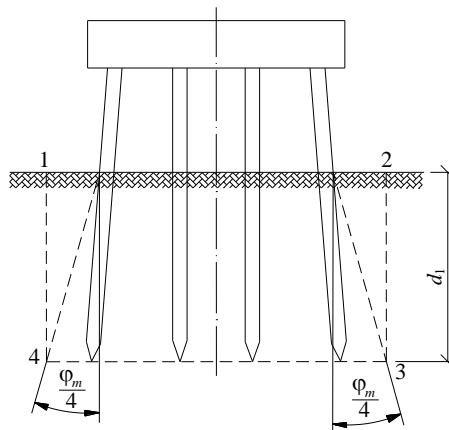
Условный свайный фундамент с ростверком, расположенным над грунтом, при угле наклона свай менее $\varphi_m/4$
